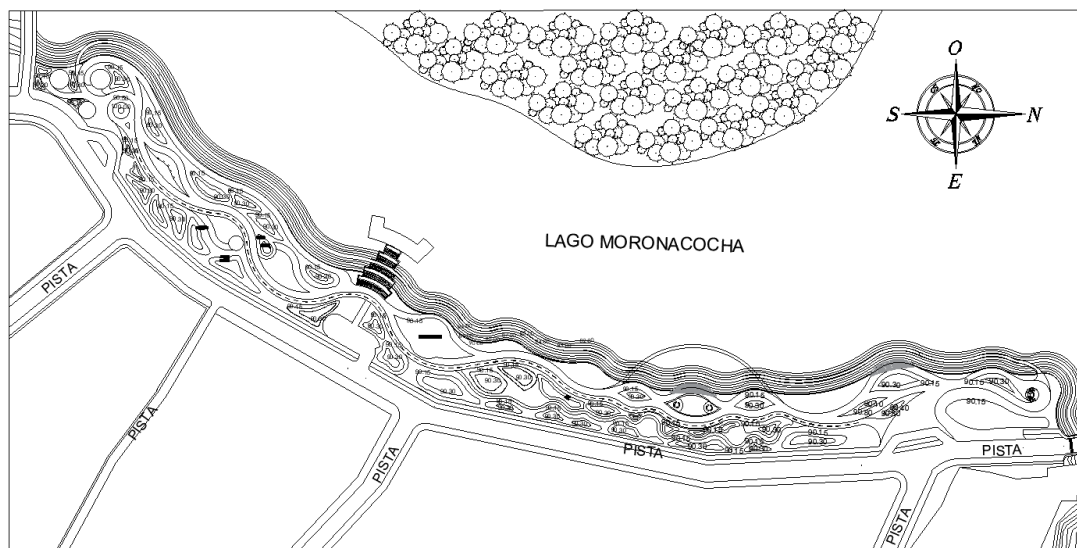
Plano de Propuesta Topográfico Del Terreno
